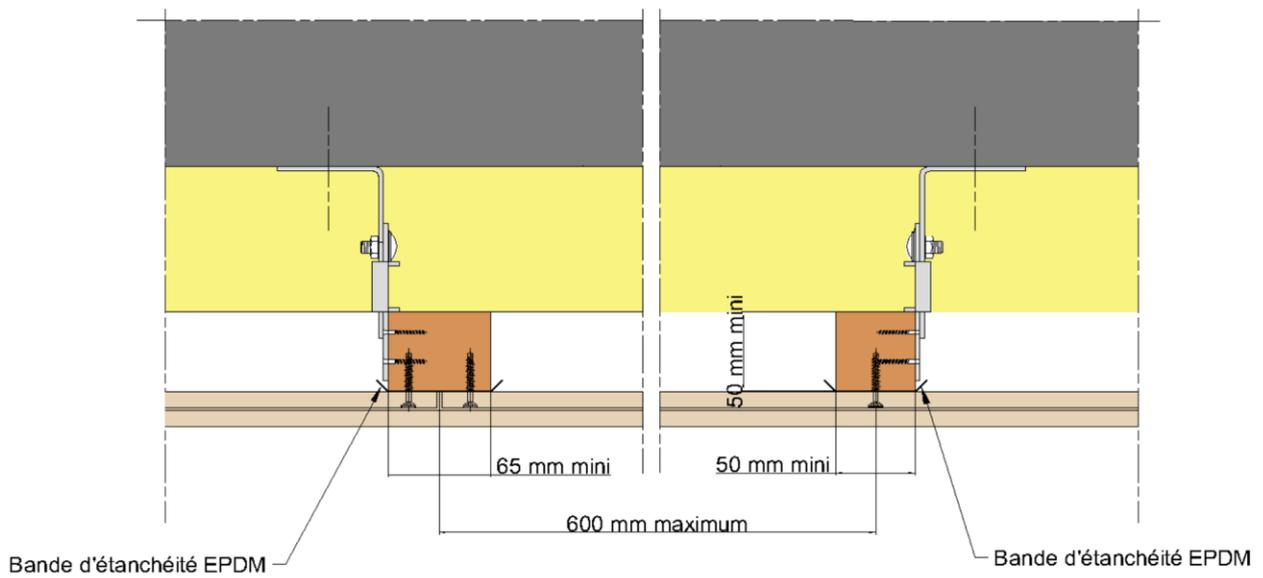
Coupe horizontale pose horizontale CEDRAL LAP
